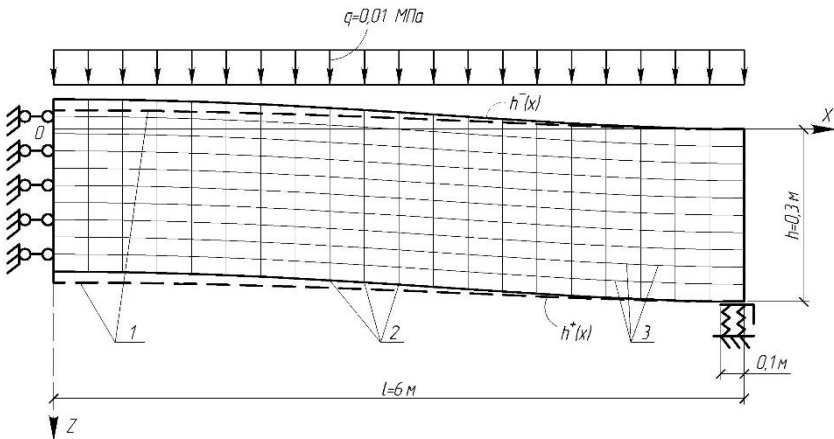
Розрахункова схема плит з будівельним вигином:
